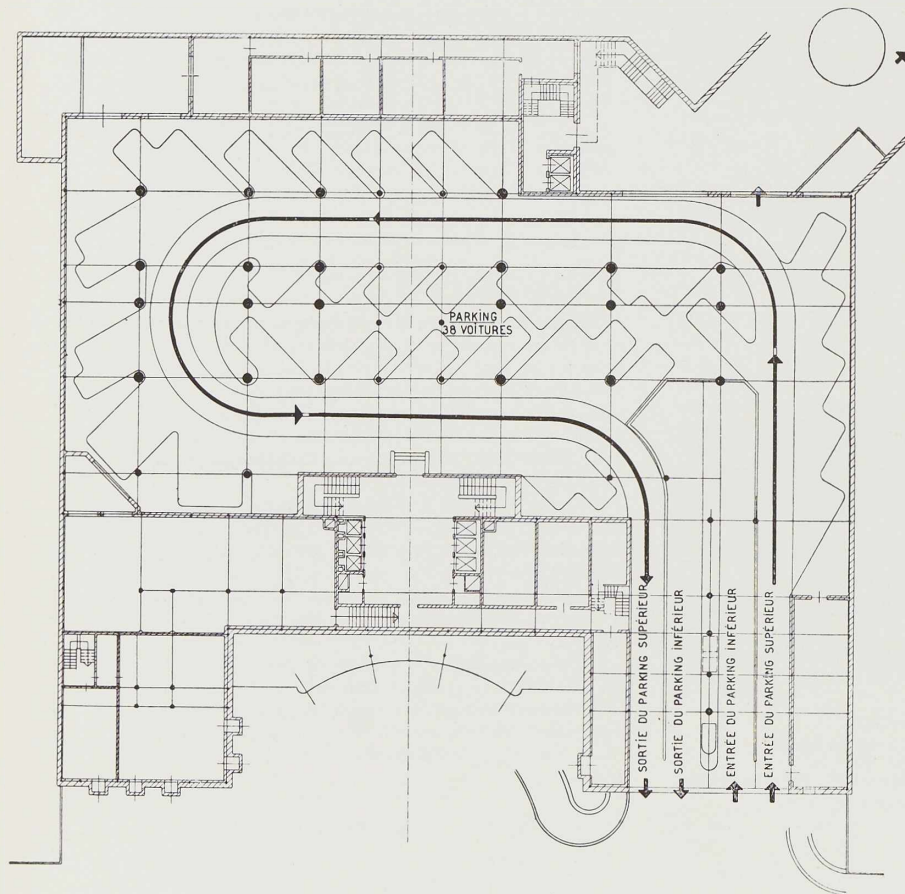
Plan du premier sous-sol contenant un parking pour 38 voitures.
